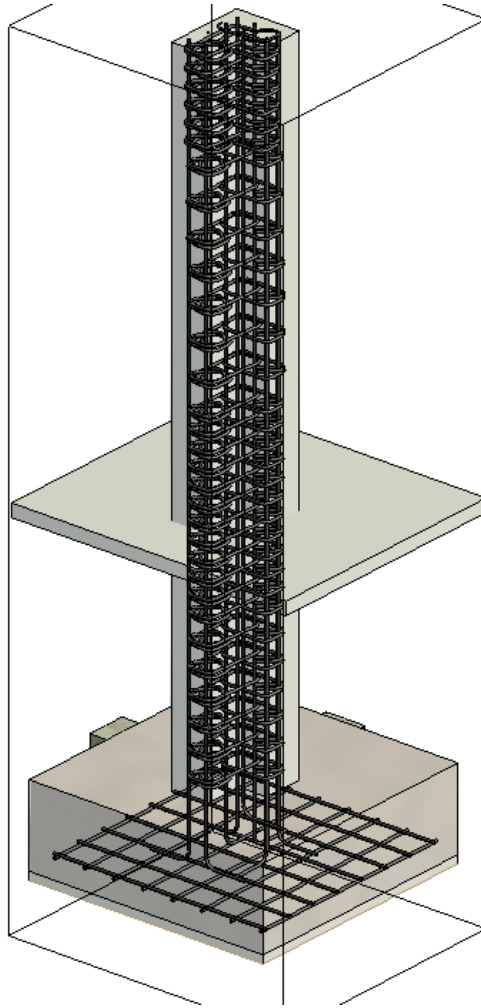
de anexo 9. Distribución del acero en la columna y zapata en Revit.
